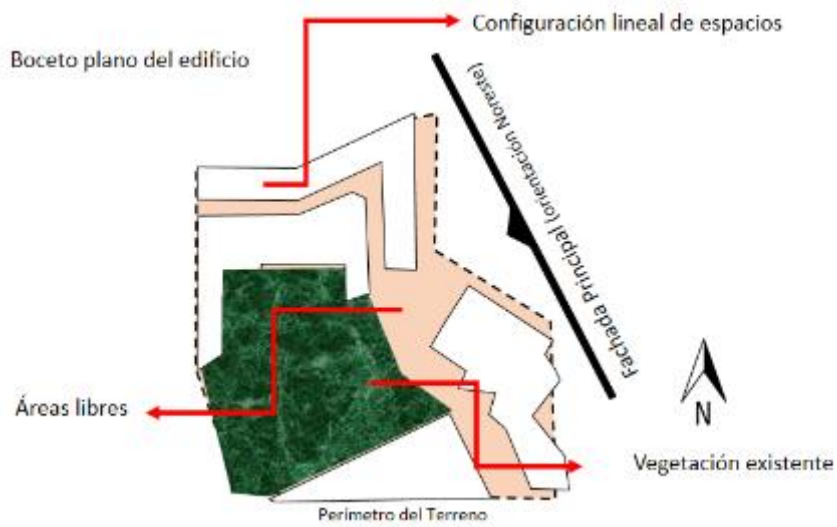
Boceto planta arquitectónica caso 5. Fuente: Elaboración propia
